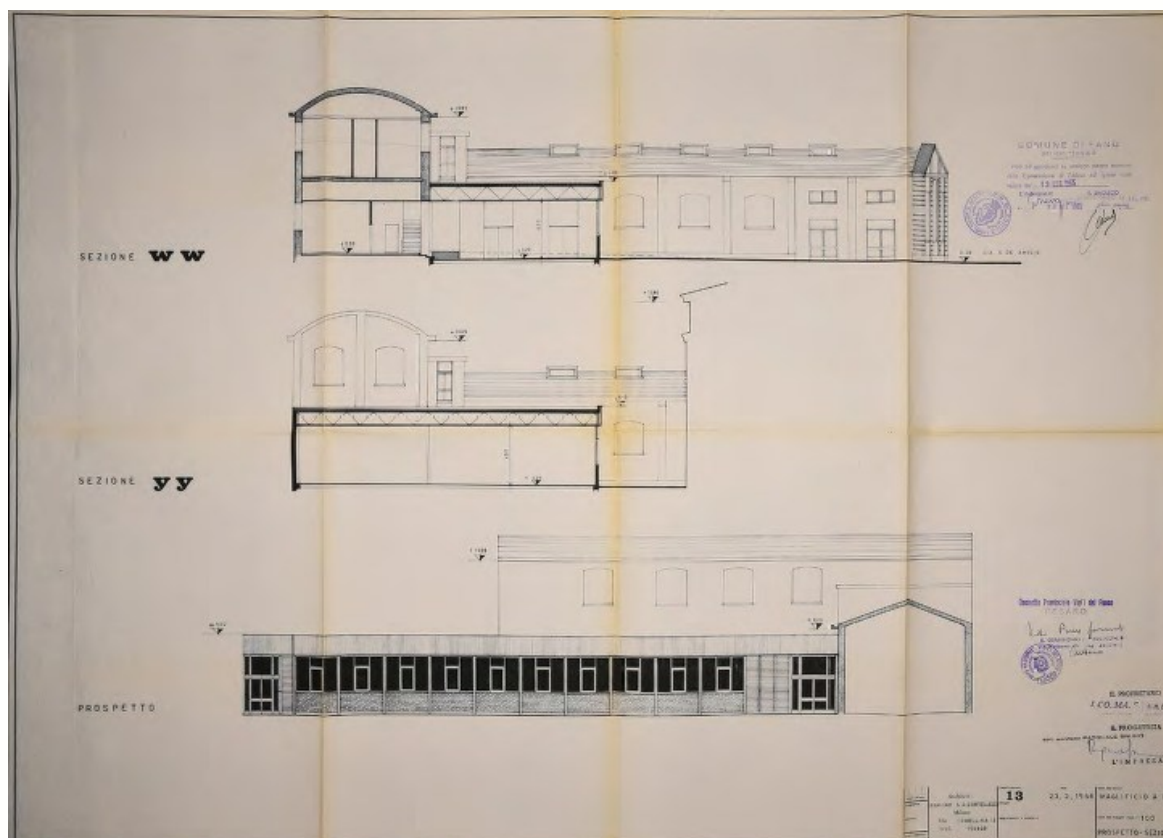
Tavola 13 del 23.03.1964 - Prospetto e sezione di progetto
